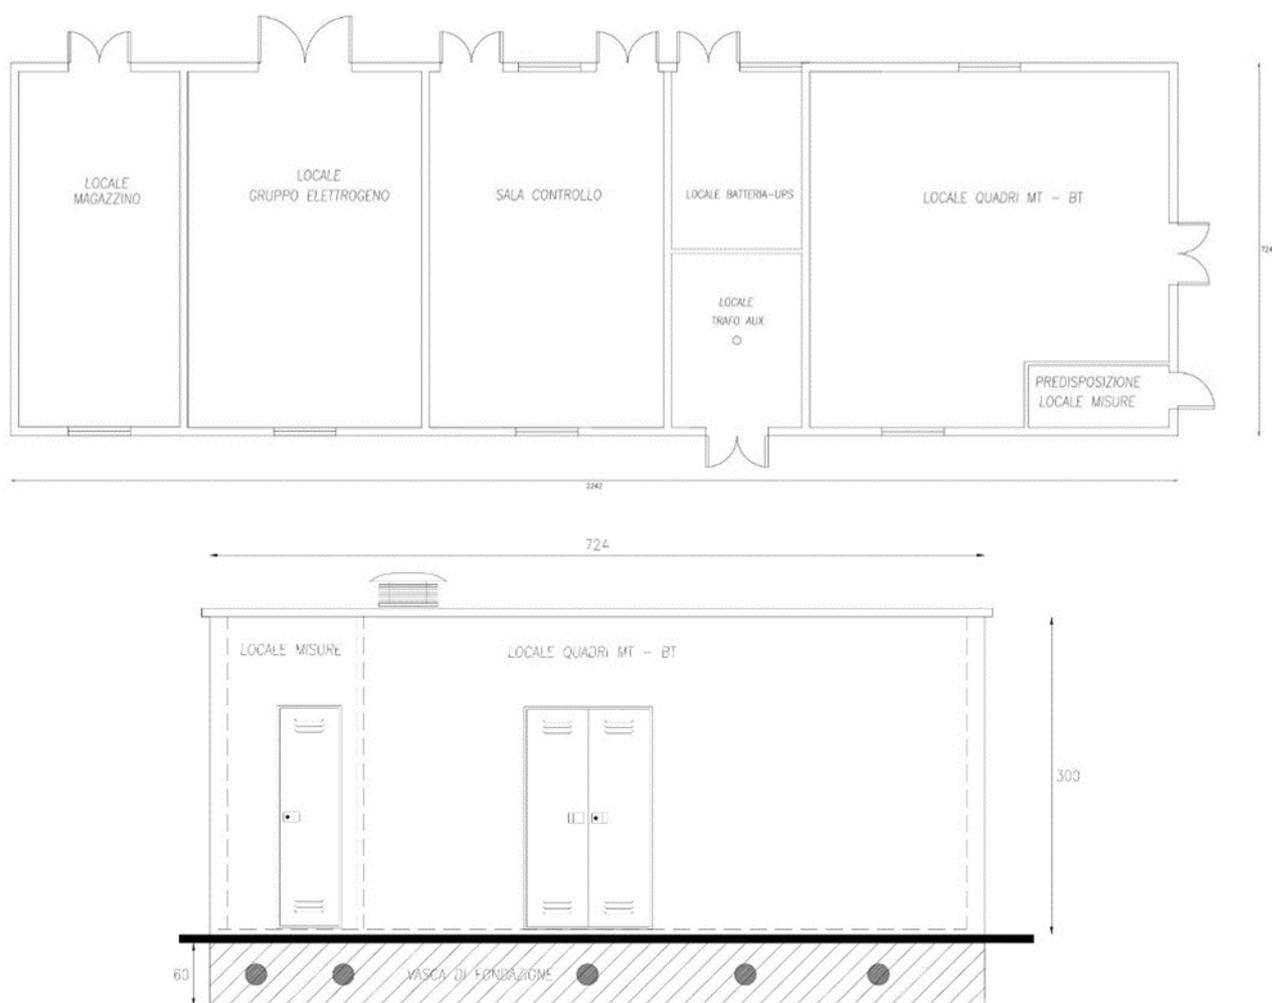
Pianta e Prospetto della Cabina Generale Utente.
